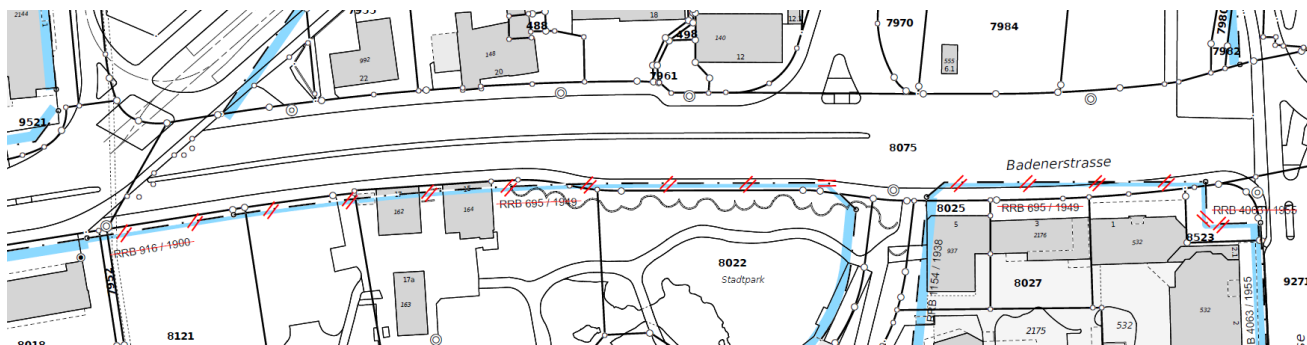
Ersatzlose Aufhebung der Staatsbaulinie entlang der alten Badenerstrasse (Quelle: Ausschnitt Situationsplan Verkehrsbaulinien, Acht Grad Ost AG)
